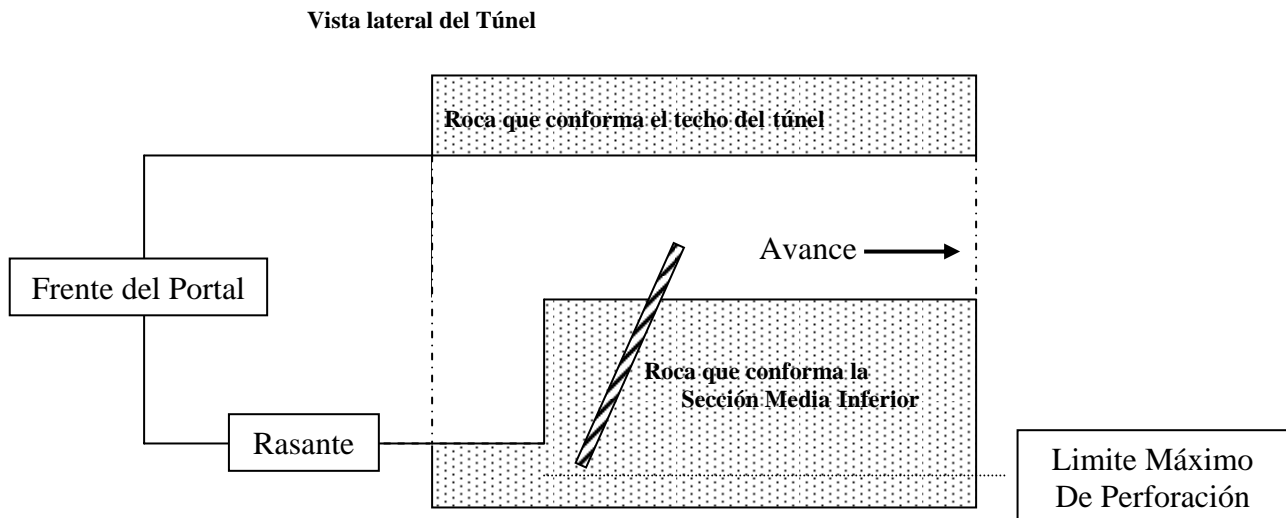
Barrenado de la sección media inferior del túnel (Banco).
